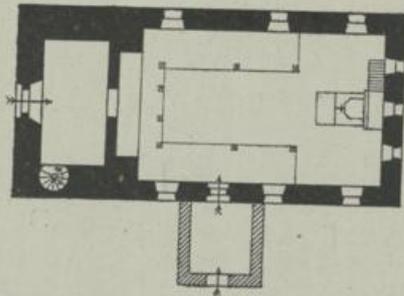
Fahrenwalde. Grundriß der Kirche
